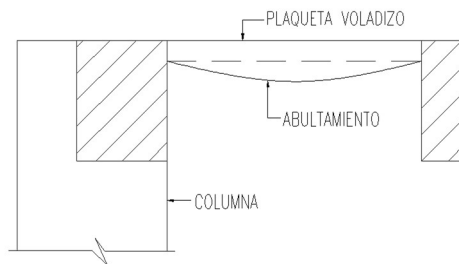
Abultamiento en plaquetas-voladizo de cubierta (archivo propio)
